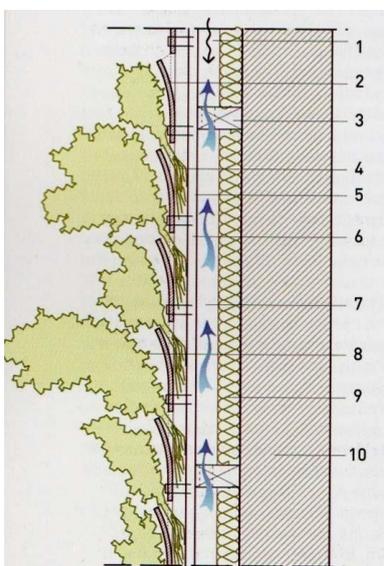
Corte explicativo de uma fachada viva hidrópica:
